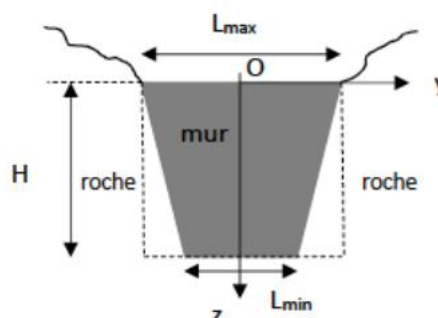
coupe d'un barrage de type Serre-Ponçon vue de face
